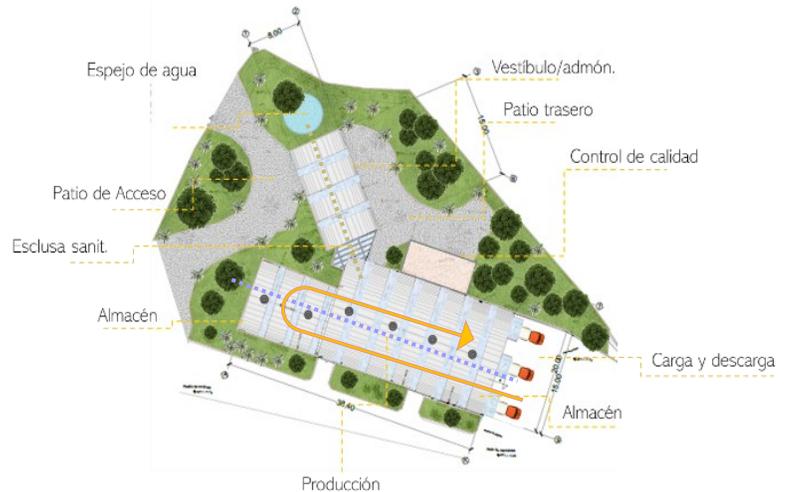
Planta Arquitectónica Composición - Elaboración propia
